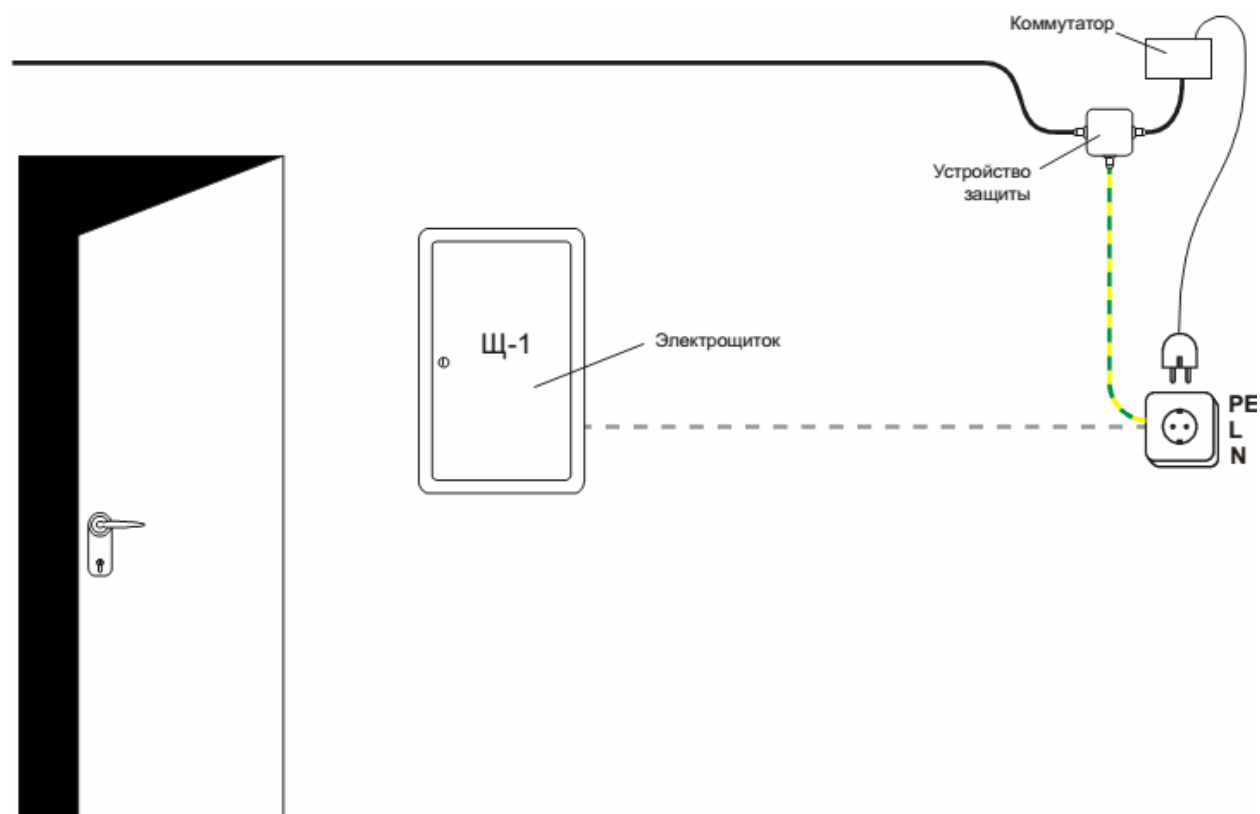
Установка оборудования в здании на стене с подключением по трехпроводной схеме.
